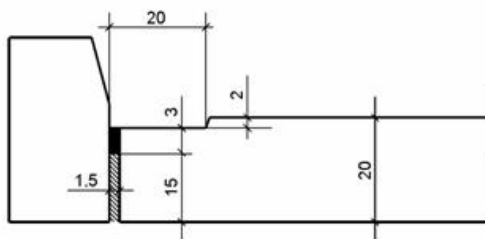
Przykłady konstrukcji szczelin w podbudowie z betonu cementowego (wymiarów w cm)
